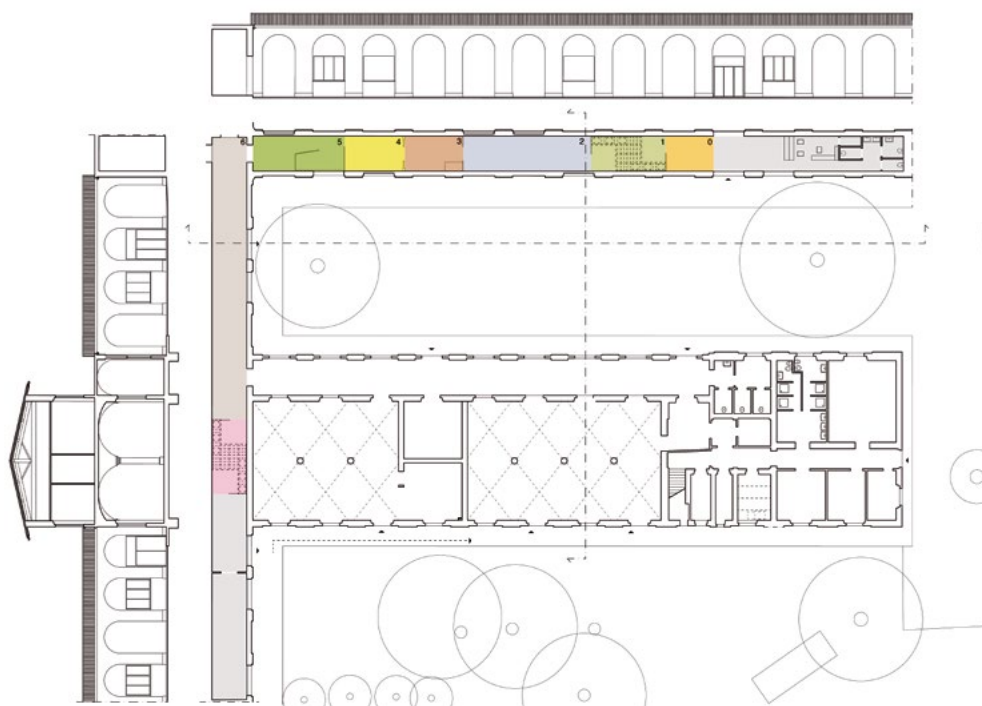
E. Martinelli, progetto del Museo della memoria di San Salvi, 2021. Planimetria, che comprende il padiglione dei Chille de la balanza, prospetto e sezione.
